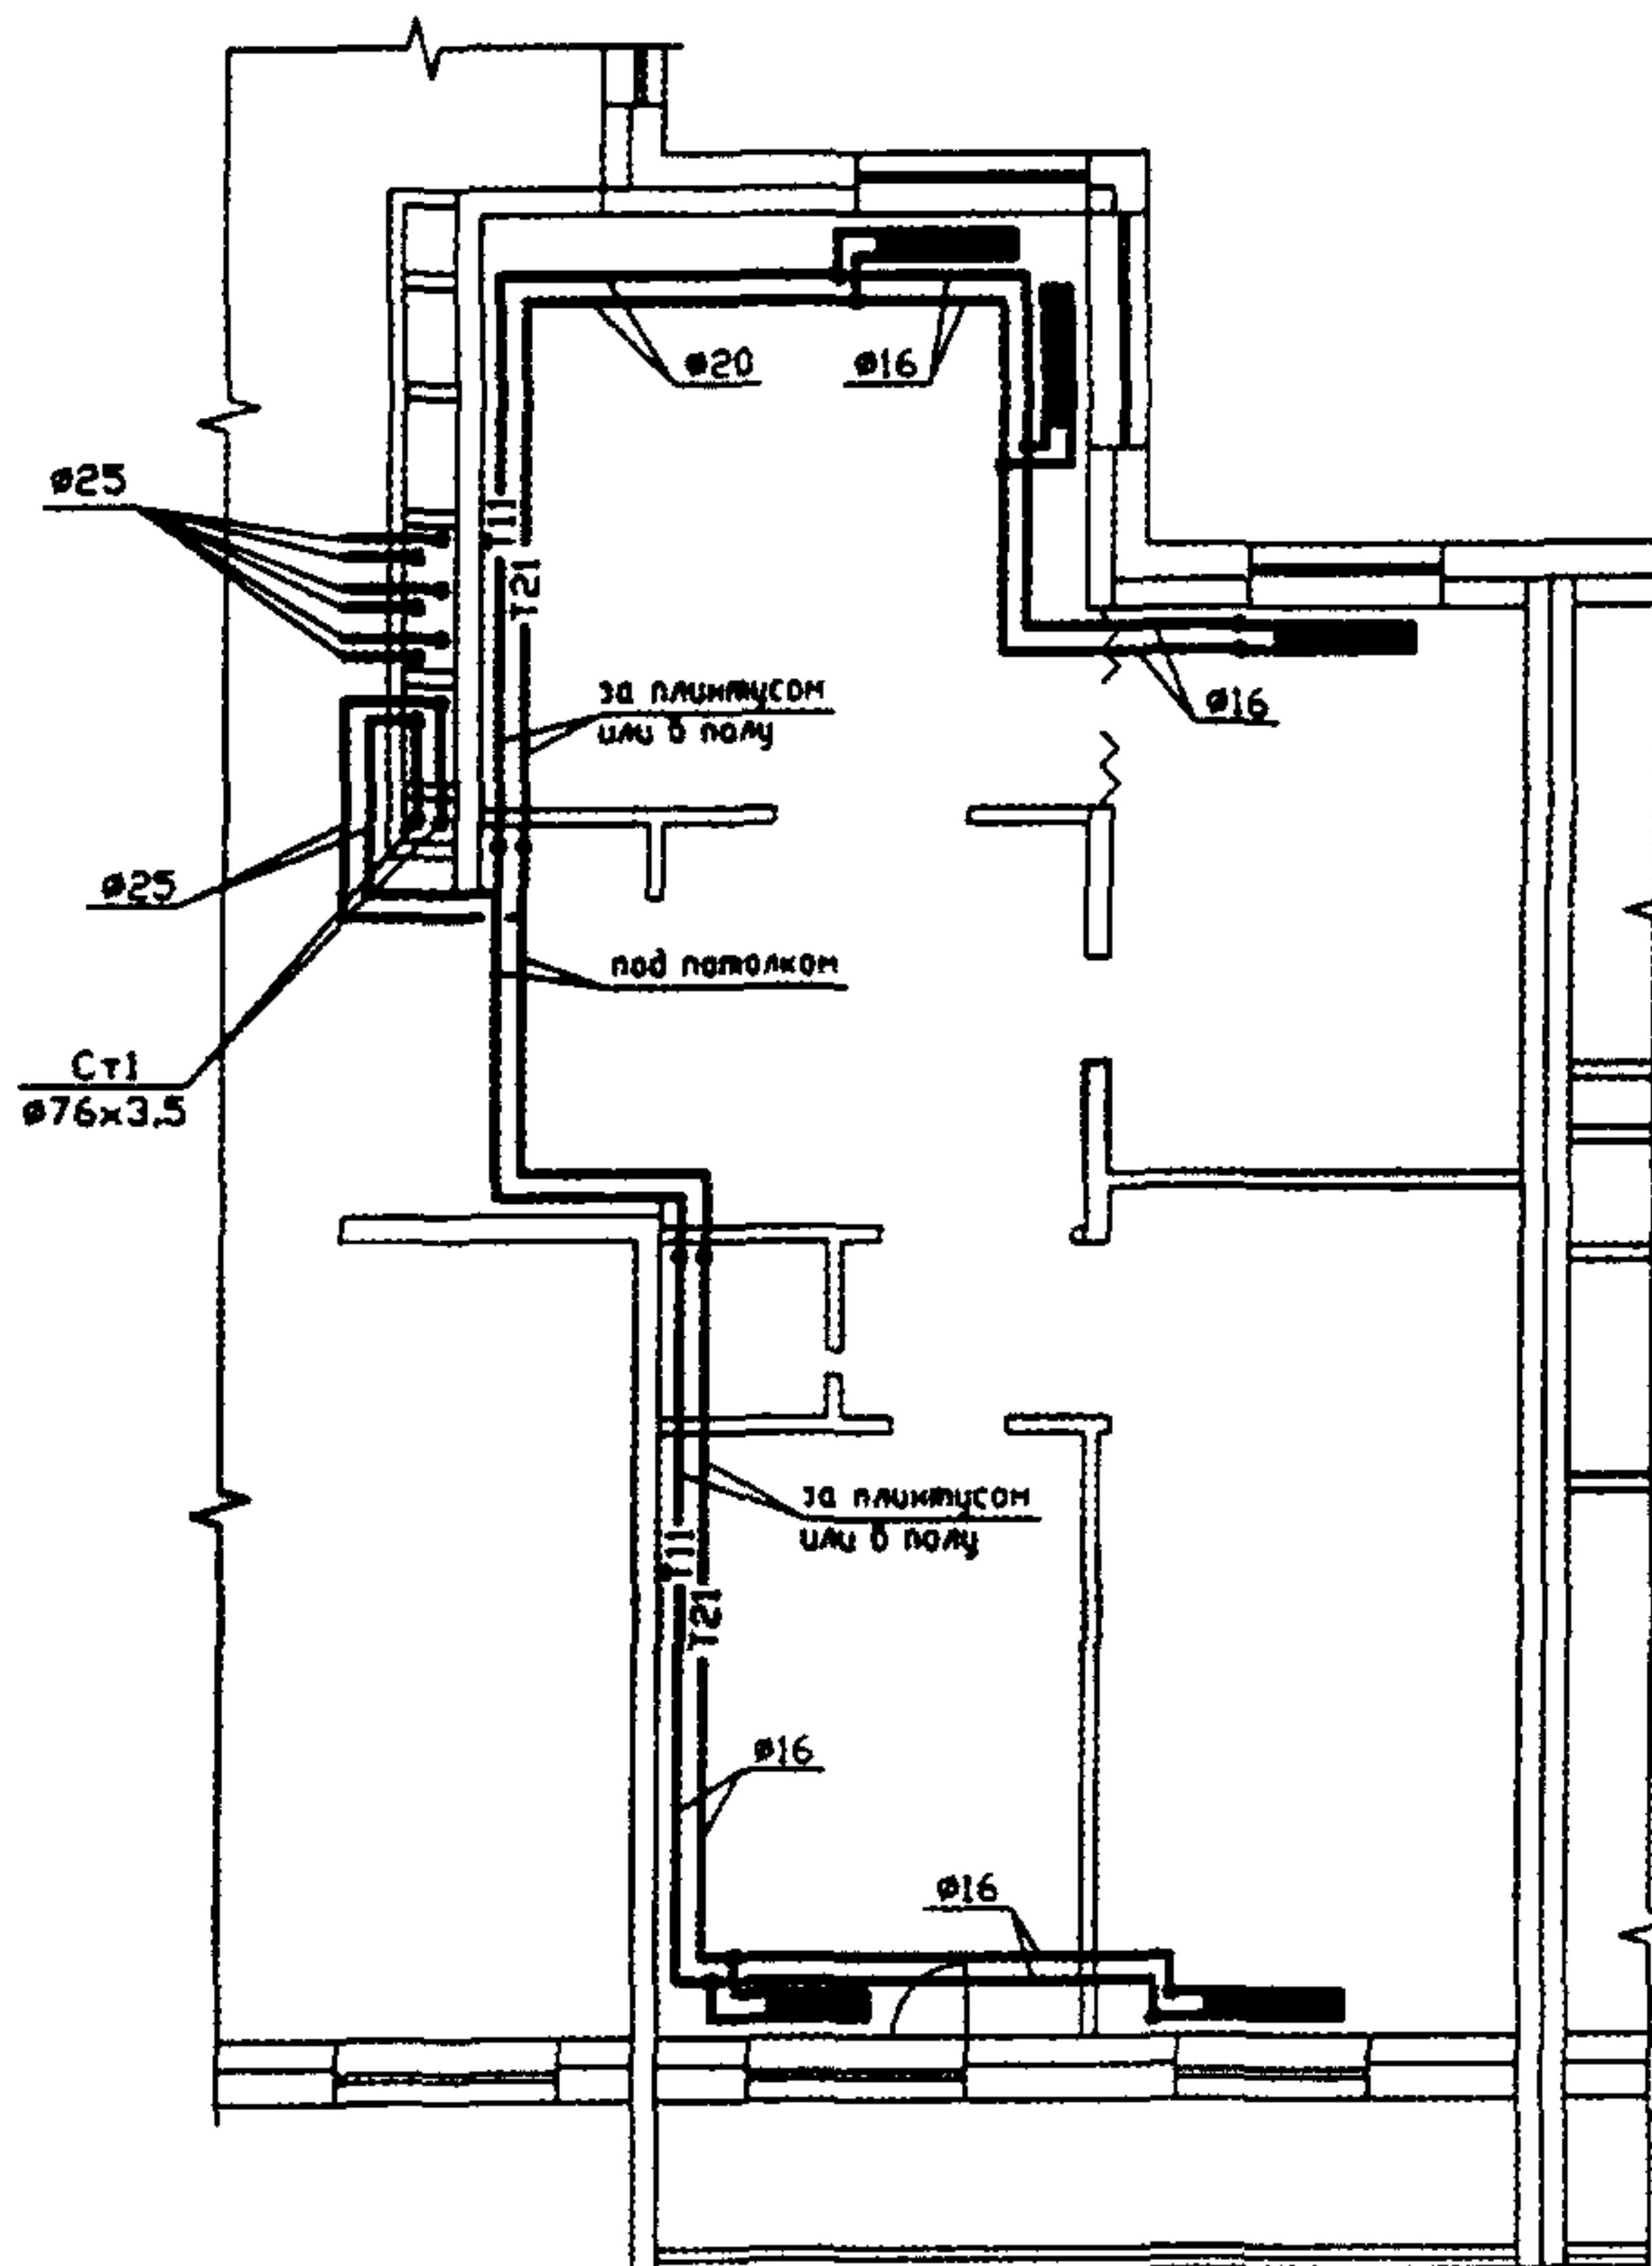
Система отопления с плинтусной разводкой теплопроводов по квартире
